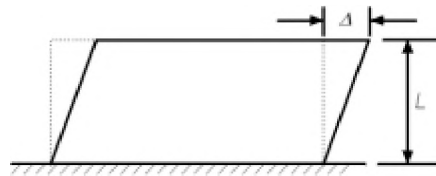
Desplazamiento lateral en un muro controlado por corte.
